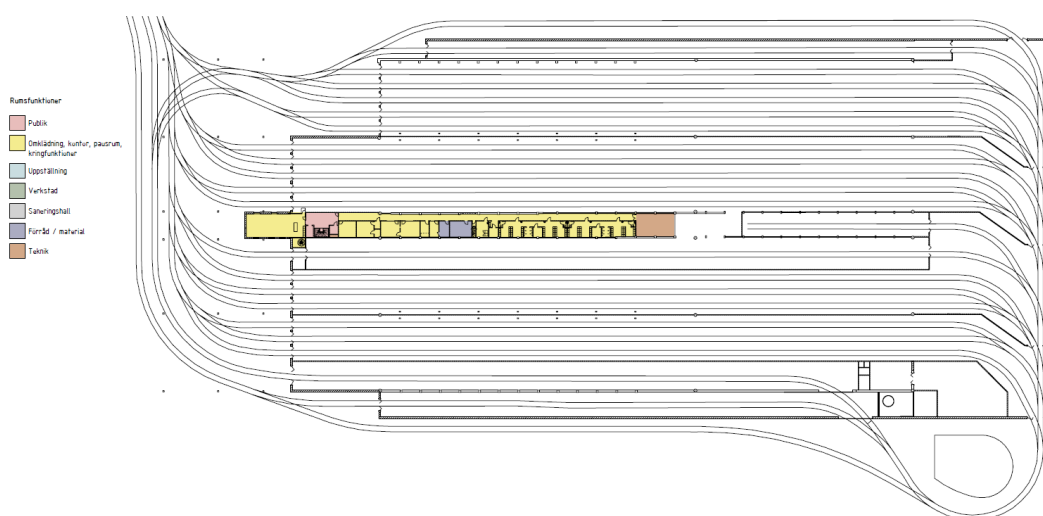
Plan befintlig byggnadsdel och tillbyggnad
